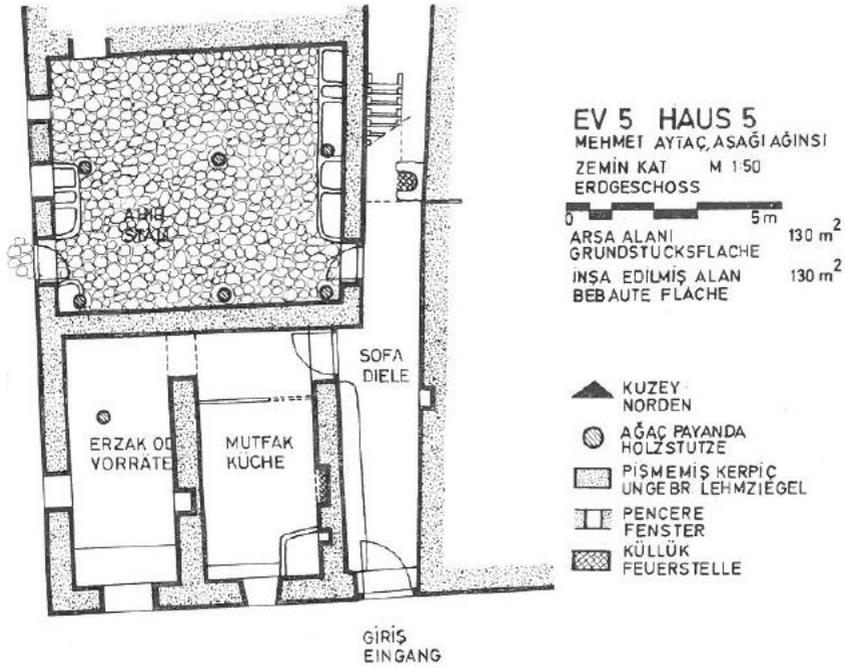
Grundriss Haus 5 mit Innendiele
